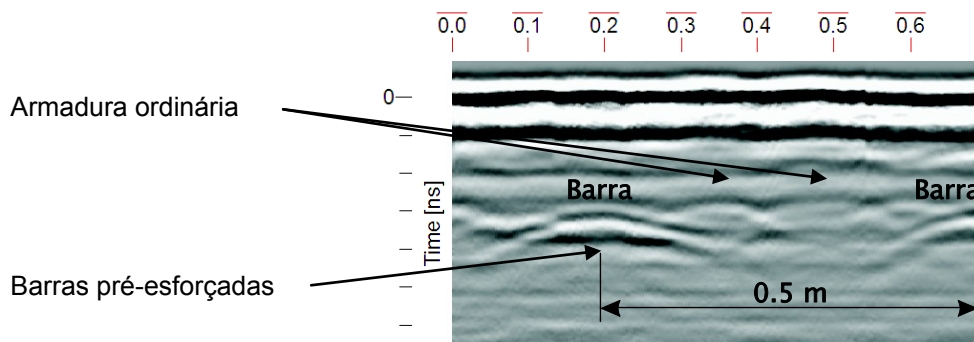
Inspeção para determinar a localização de barras pré-esforçadas embebedas no tabuleiro. Exemplo de radargrama ilustrando a detecção de duas das barras pré-esforçadas.
